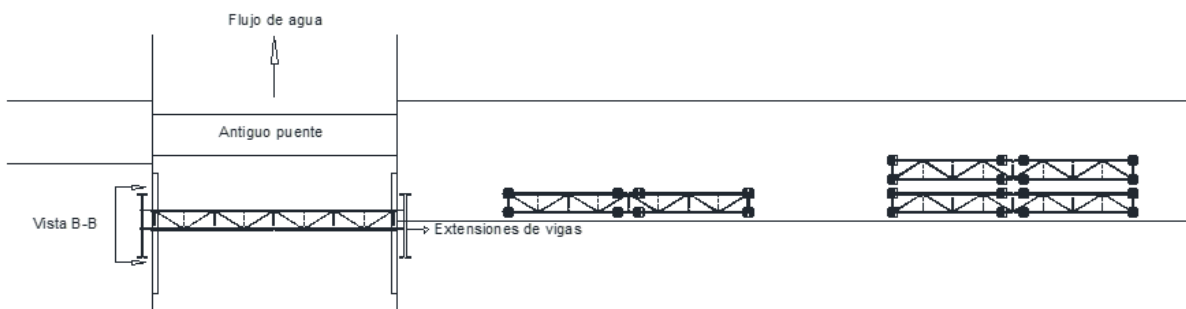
Movimiento transversal del primer par de vigas usando los pórticos
